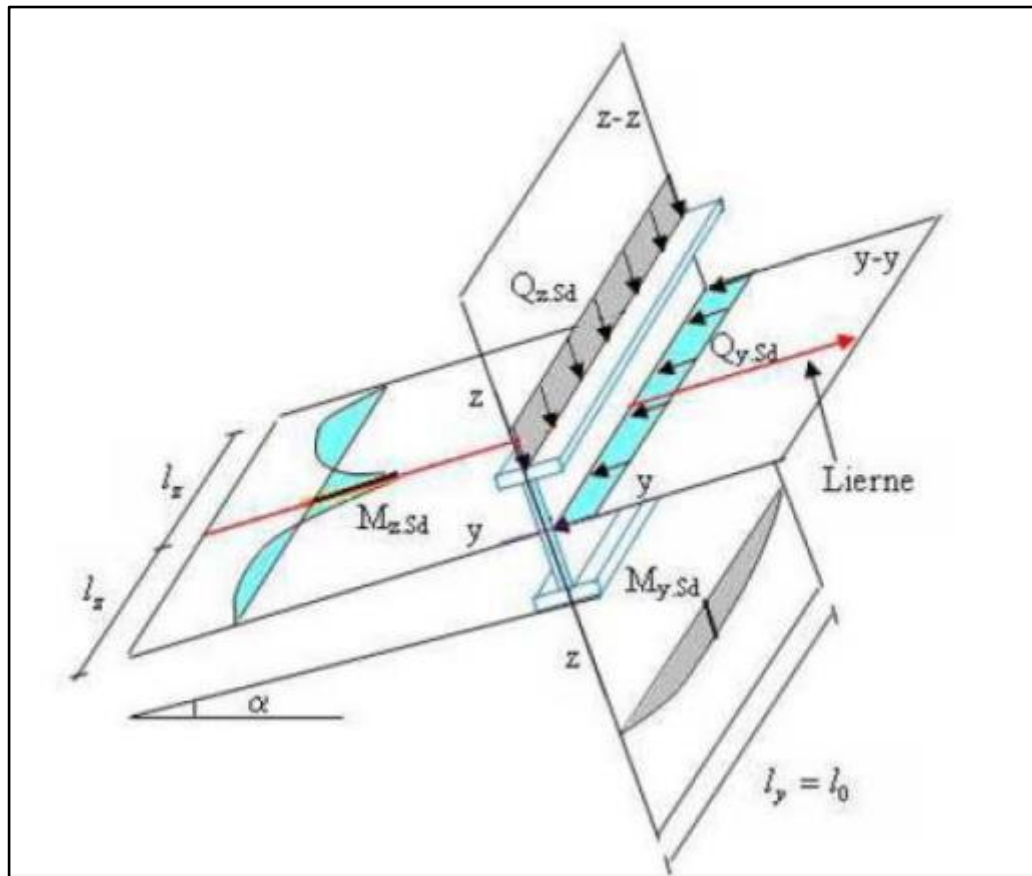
Panne de toiture en flexion sous les différents plans de chargement.
